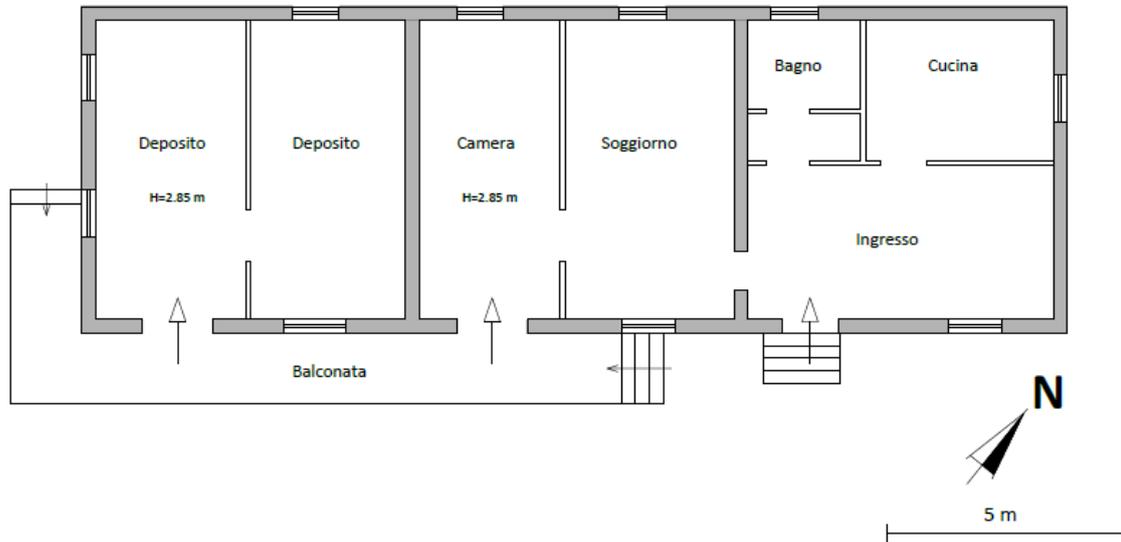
Pianta piano terra dello stato reale dei luoghi – Foglio 15 part. 3328 sub. 1 (da accatastare)
